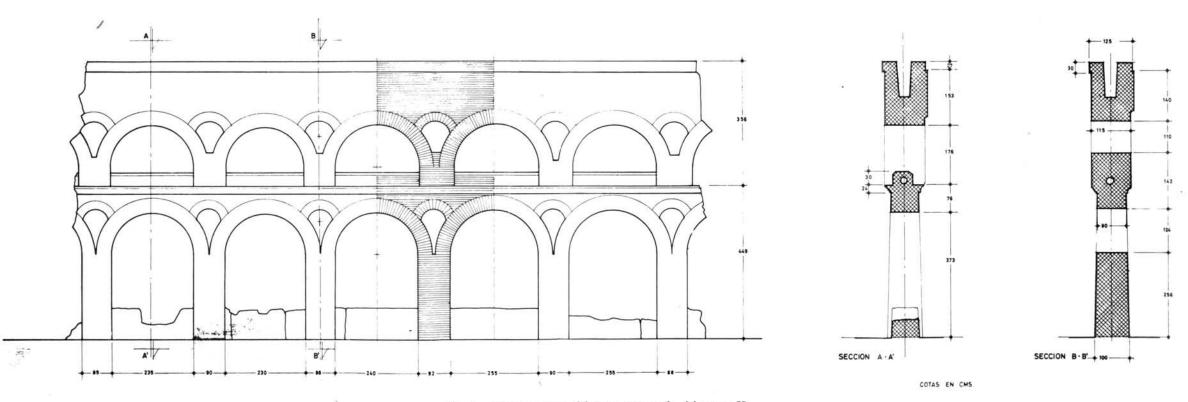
Alzado y cortes del trozo conservado del tramo II.
